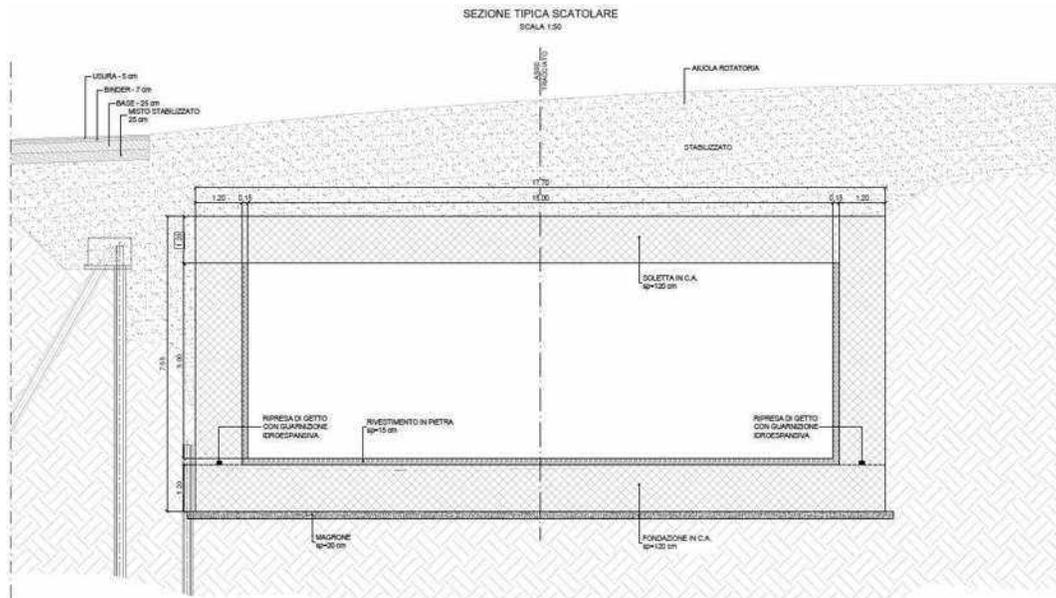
Manufatto scatolare idraulico torrente Faidana. Sezione trasversale
